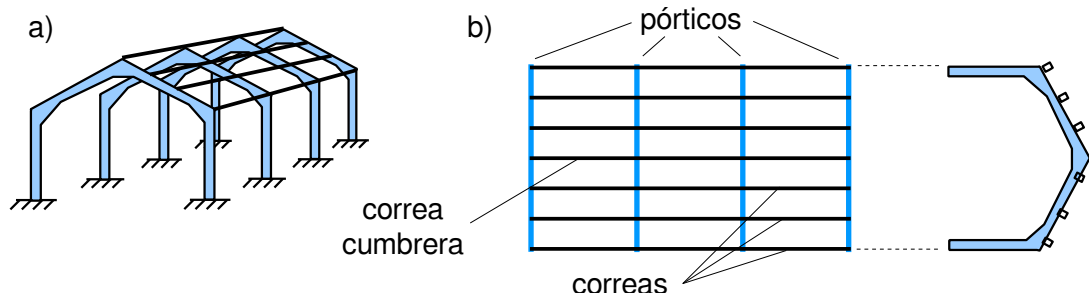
a) Algunas correas de la nave. b) Vista en planta y alzado.
